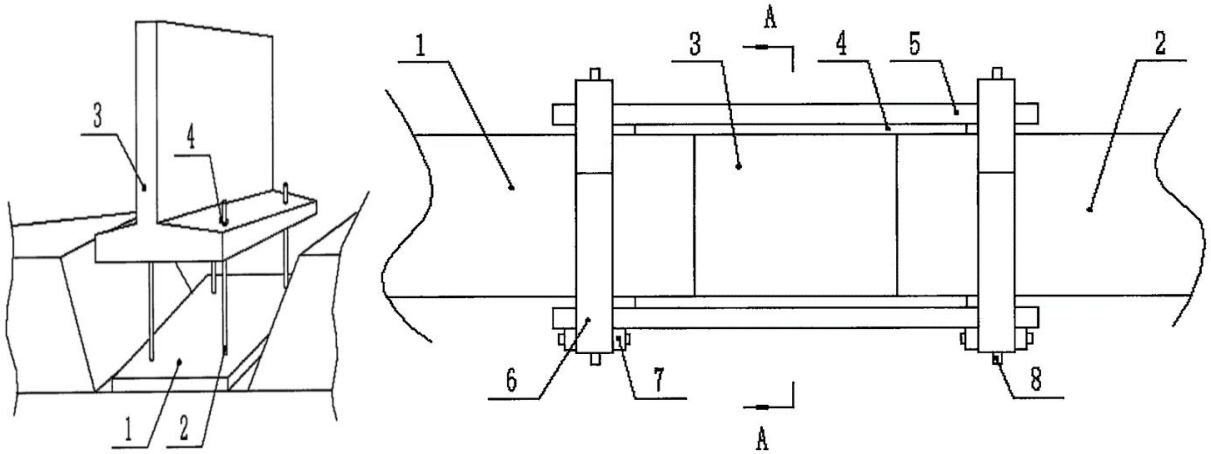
装配式防火墙立面图（示意） 图 10.4.3-2 一种装配式防火墙后浇带定型模板（示意）
